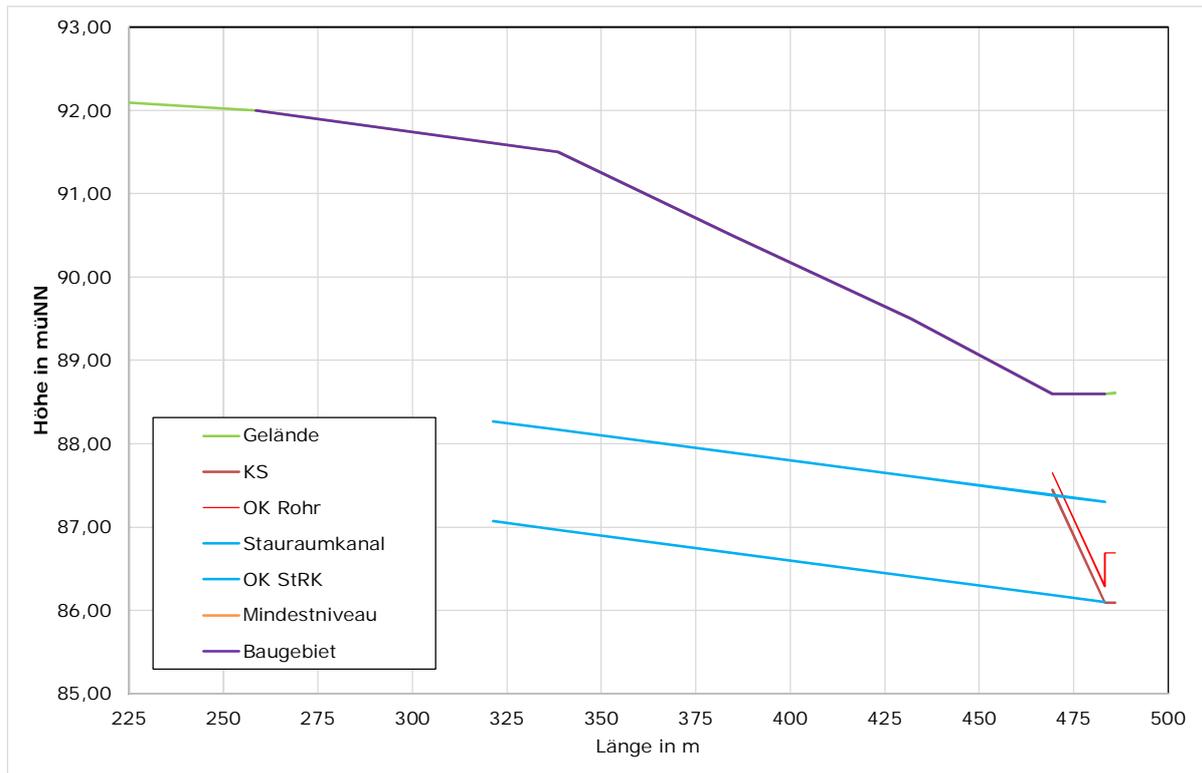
Denkbarer Stauraumkanal DN 1.200
